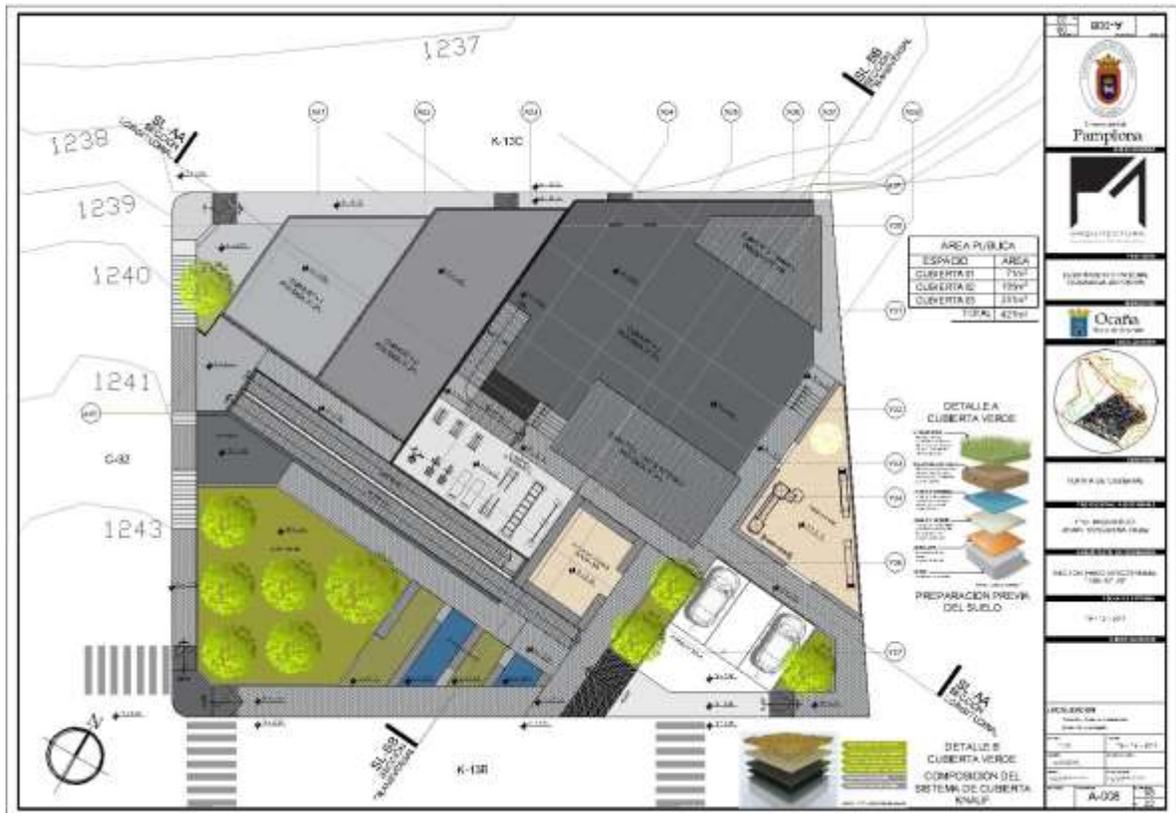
Planta Arquitectónica Nivel + 5.15.
